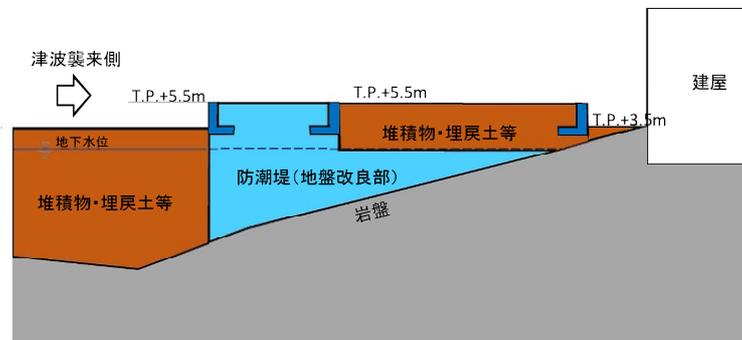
地盤改良部 断面図 (F-F 断面)
